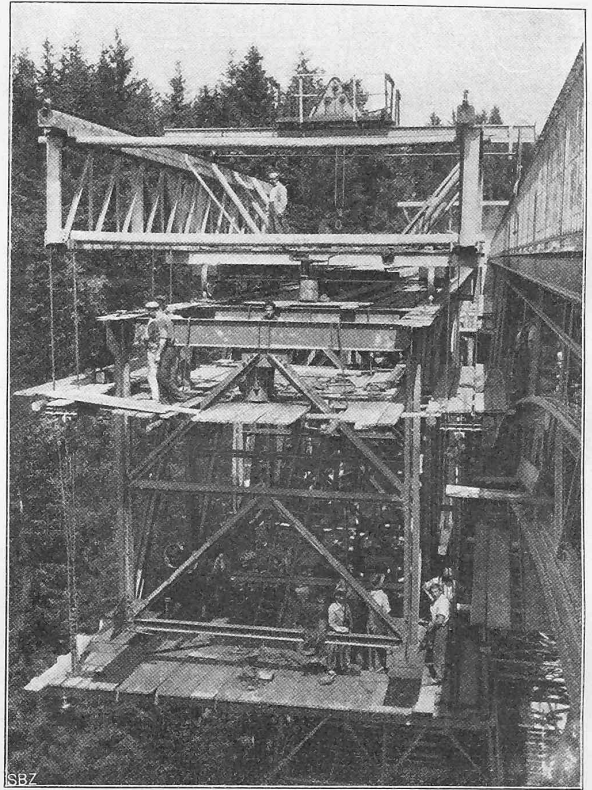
Hauptträger während der Montage mit dem fahrbaren Montiergerüst.
